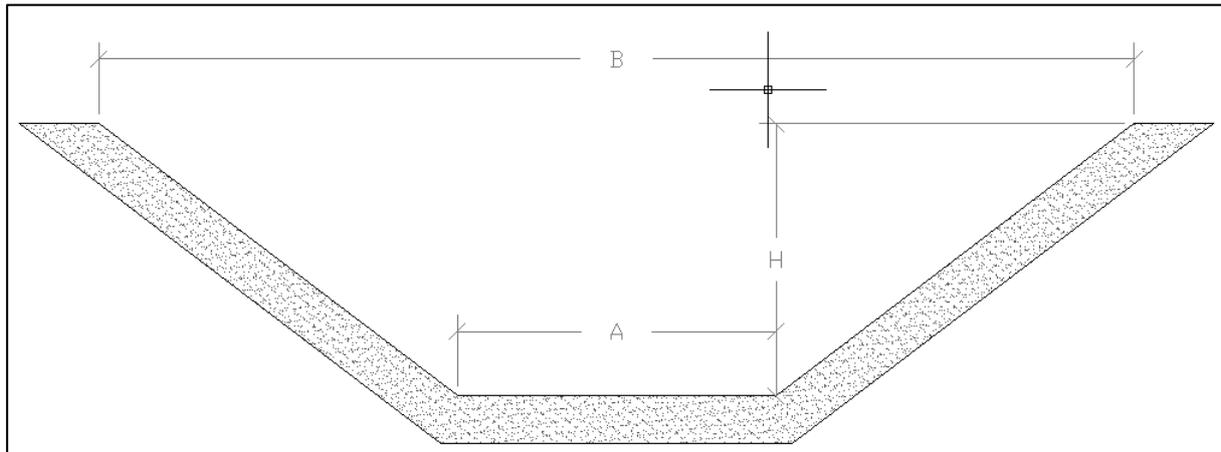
Sección Tipo trapezoidal del cana de Villadangos.
